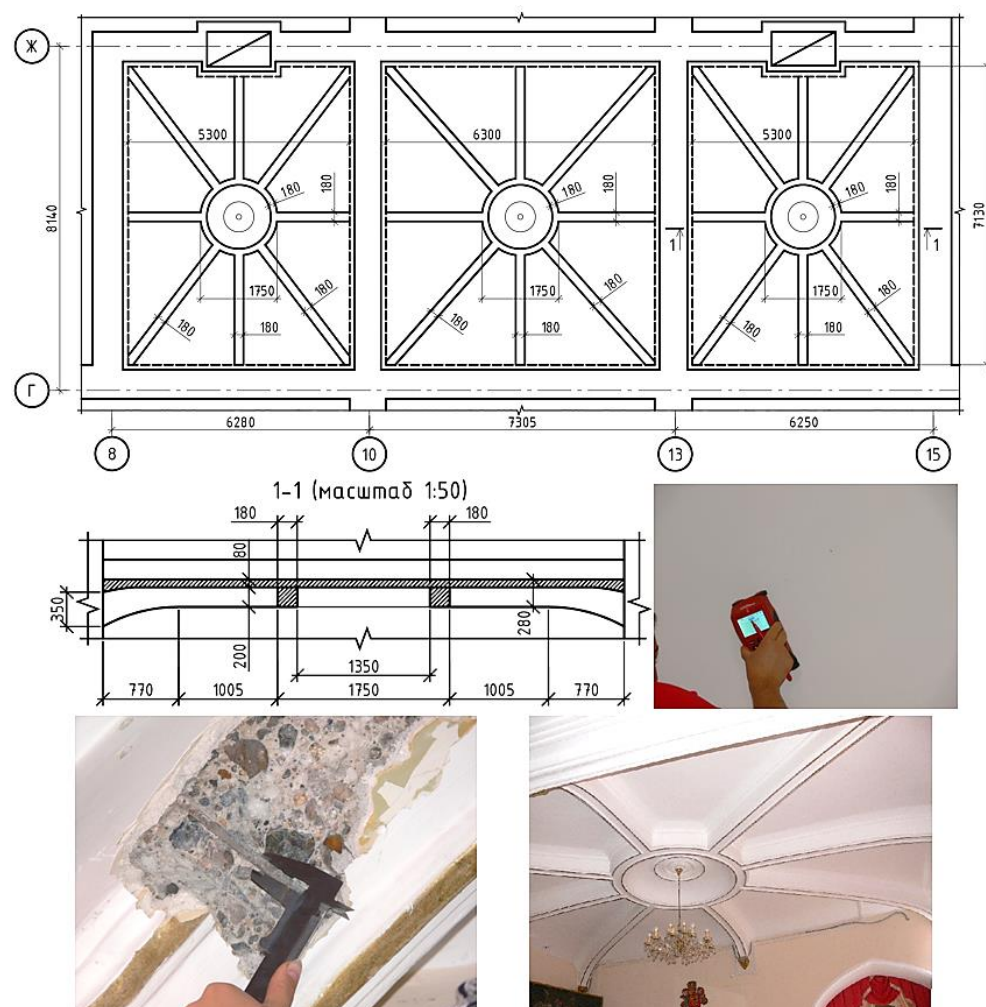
Определение конструкции перекрытия над фойе первого этажа
